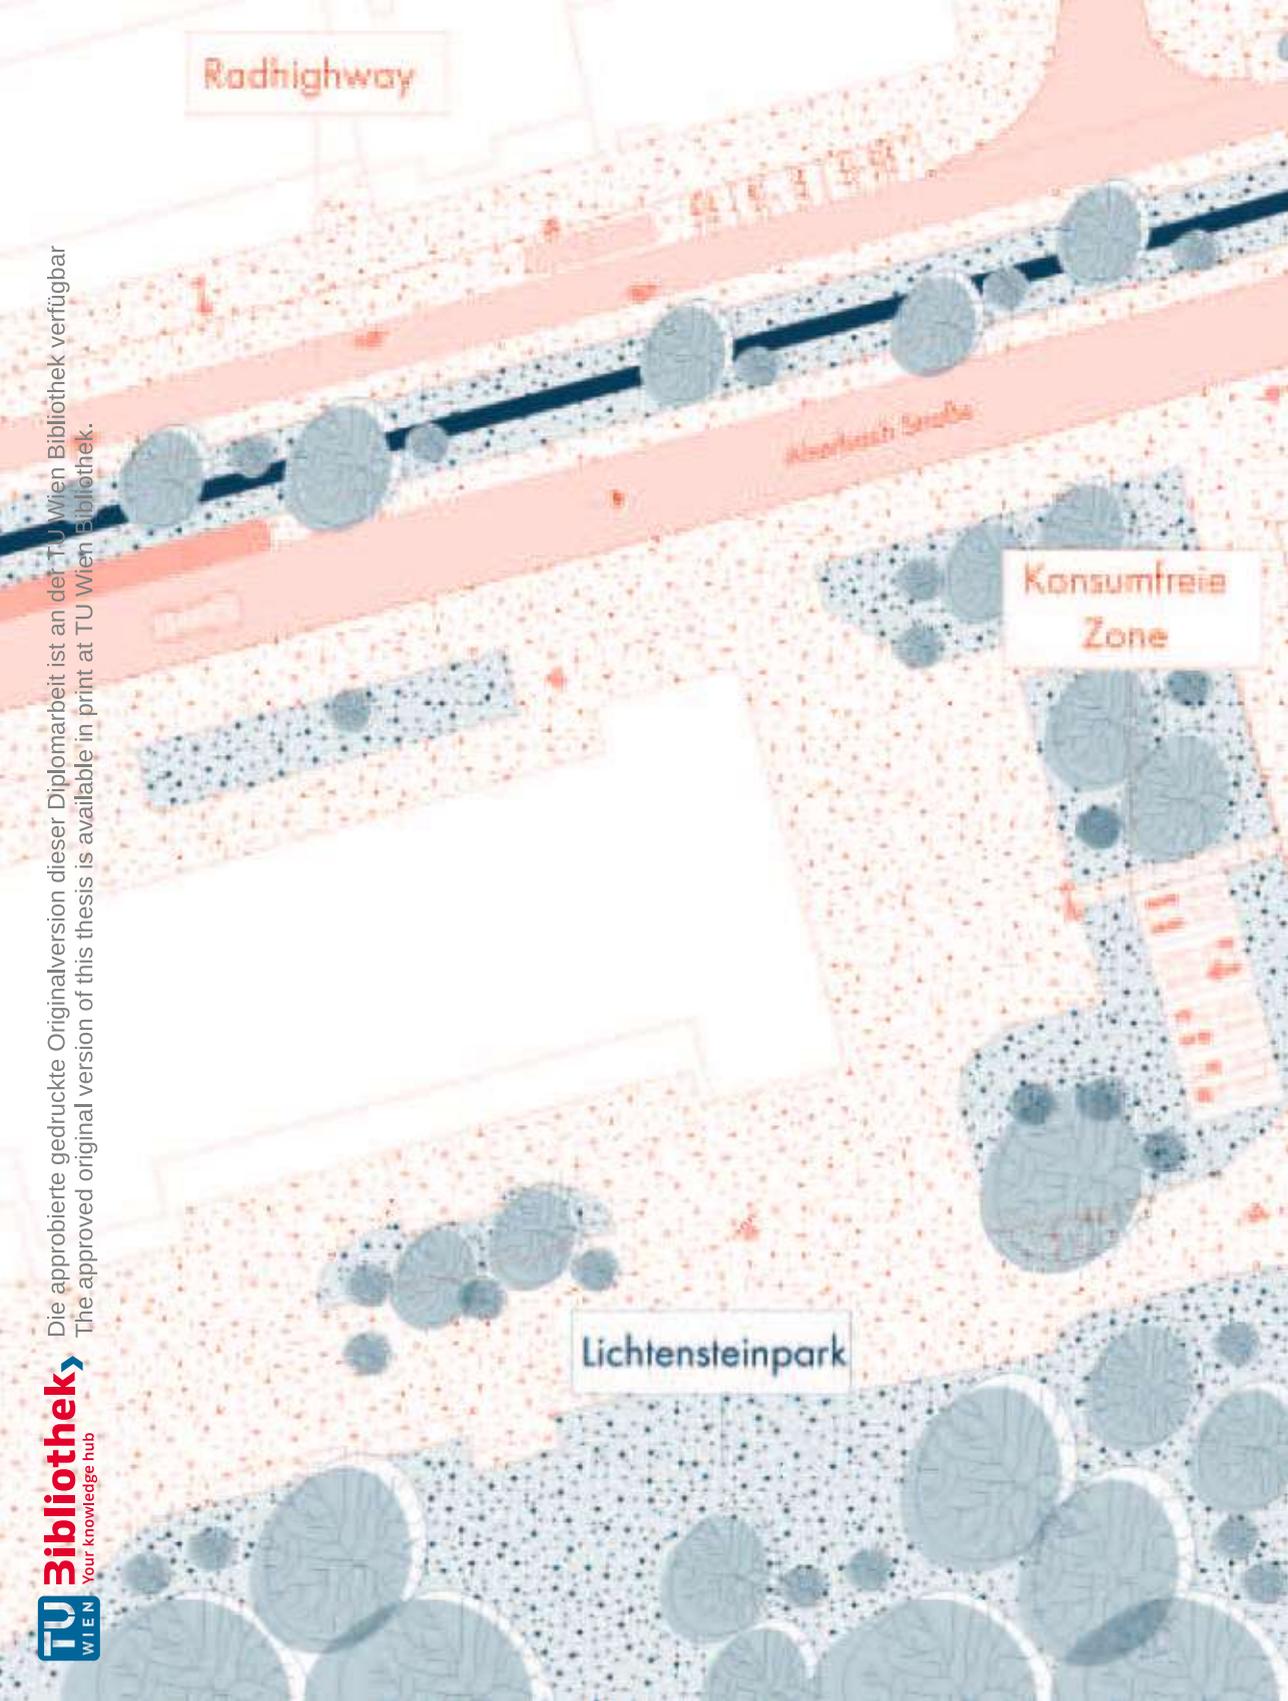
| Grundriss 1:500 - Lichtensteinpark mit neuem Parkzugang 2
